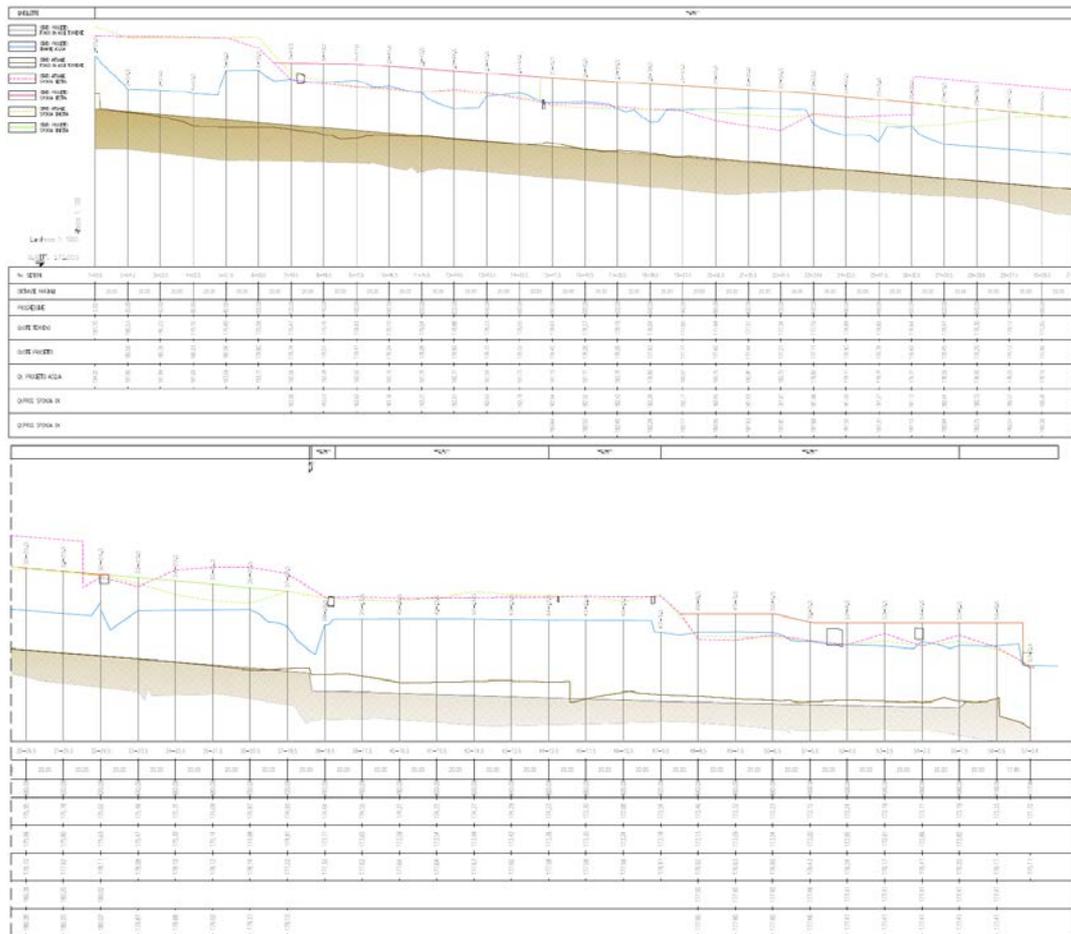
Estratto Tavola 05. Stato di progetto, profilo.
